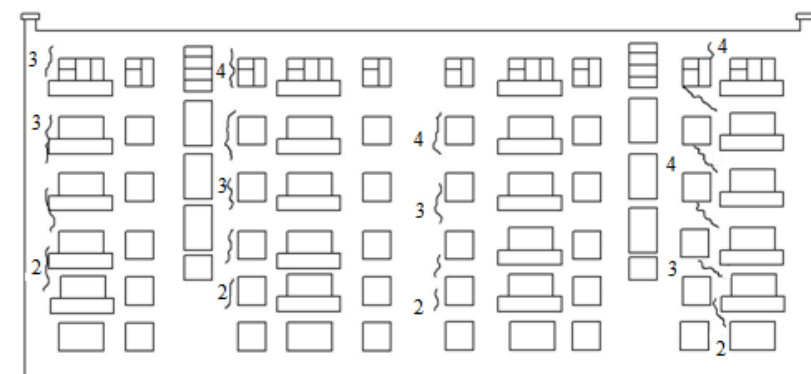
Дом 48. Трещины стены дворового фасада
